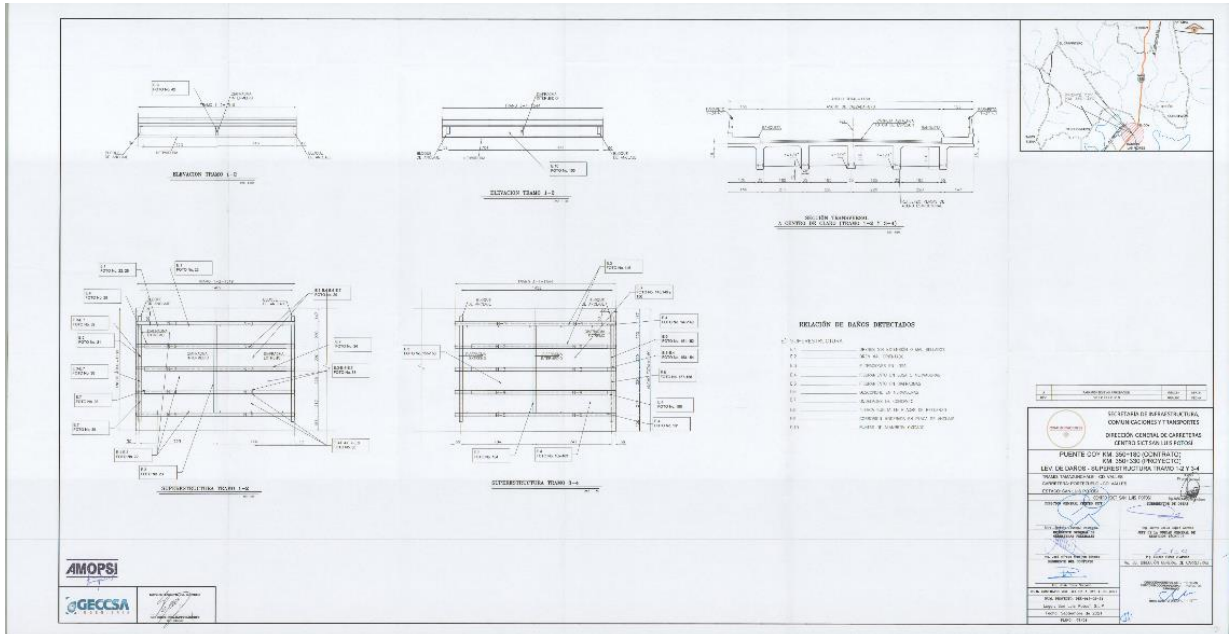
Vista en planta y perfil de la estructura. (Elaboración propia)
